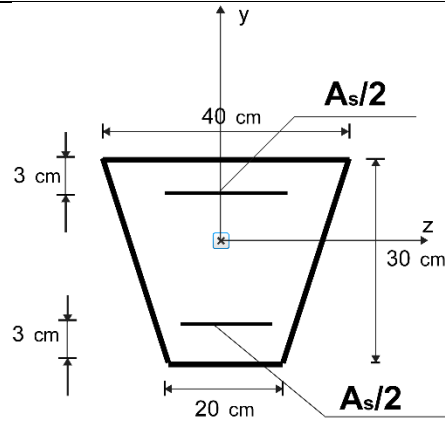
Seção trapezoidal e disposição das armaduras para o P1
